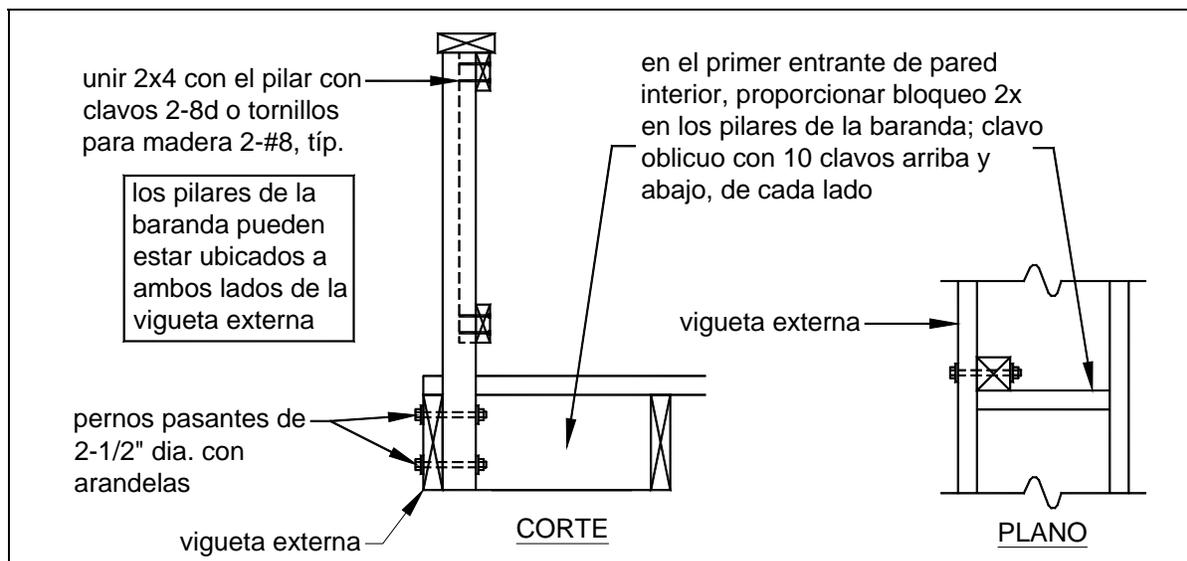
DETALLE SOBRE LOS PILARES DE LA BARANDA CON LA VIGUETA EXTERIOR
